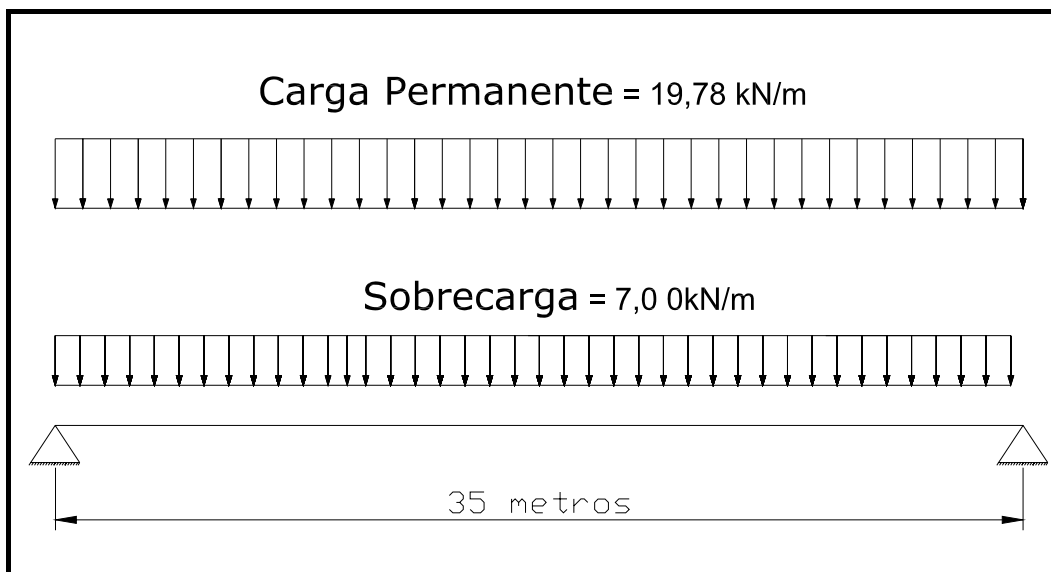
Esquema estrutural adoptado para a análise longitudinal da viga
